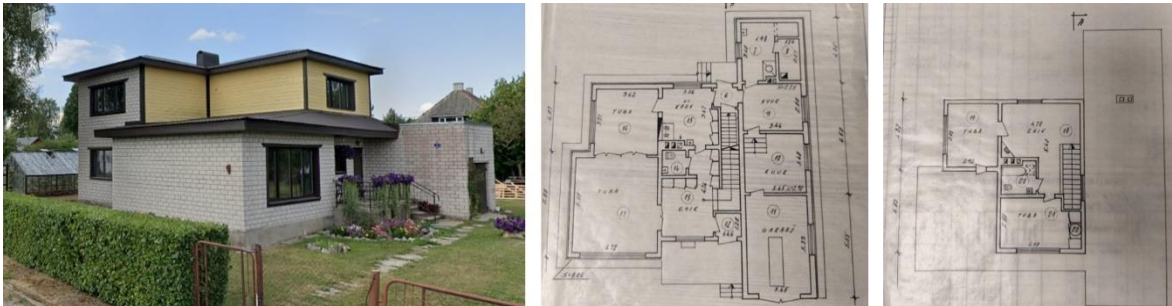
Lõuna põik 4 (1973) in Väike-Maarja (left to right: view, ground floor layout and upper floor layout)
